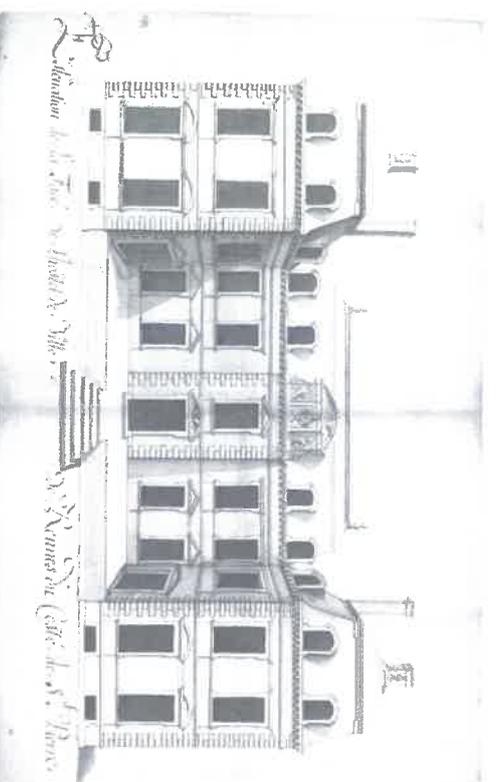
Projet de reconstruction de l'ancien Hôtel de ville, rue de la Monnaie - « Elevation de la façade de l'hôtel de ville de Rennes du côté de St Pierre » (source : archives.rennes.fr - 2F1245)
